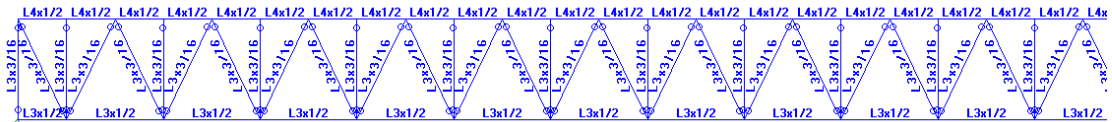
Perfis viga treliçada TIPO C – Tesoura Warren (a)
